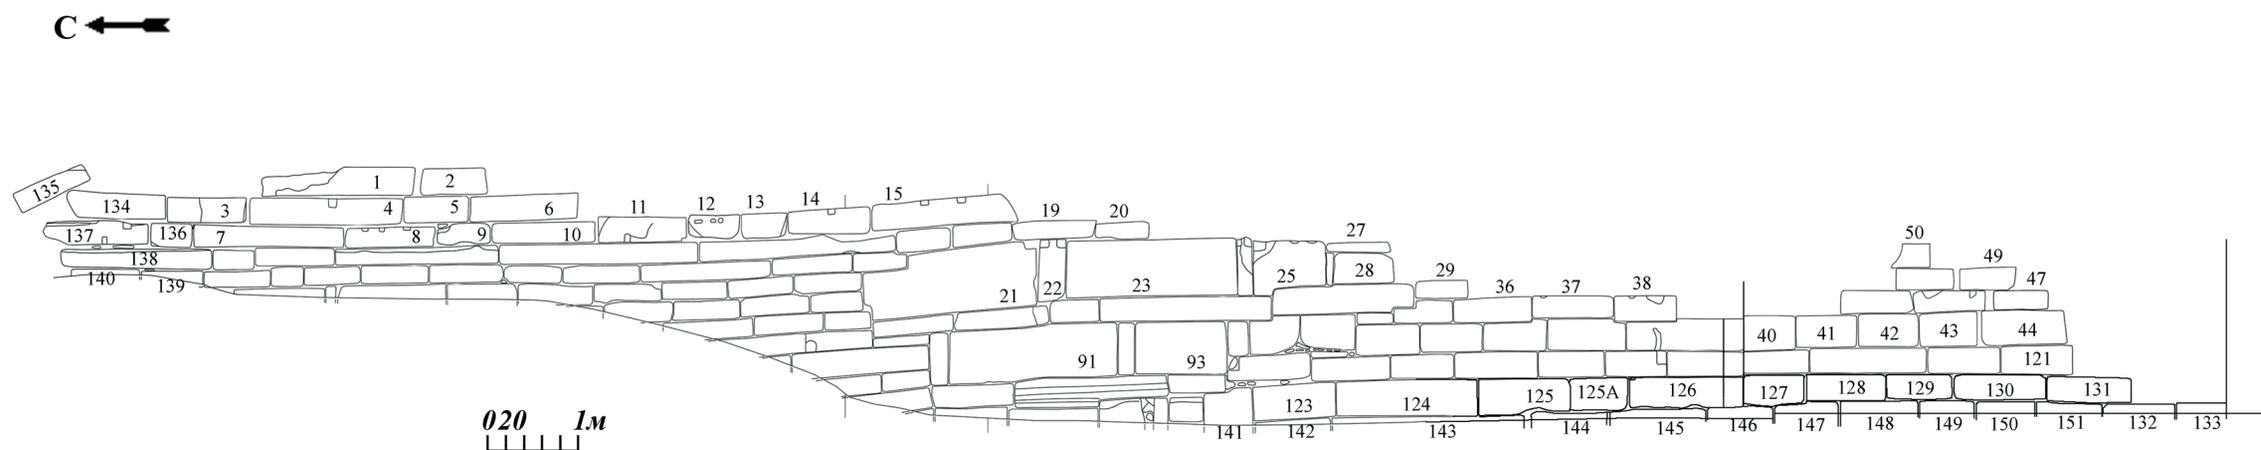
Монументальное архитектурное сооружение на р. Рубас. Западный фас стены №2
